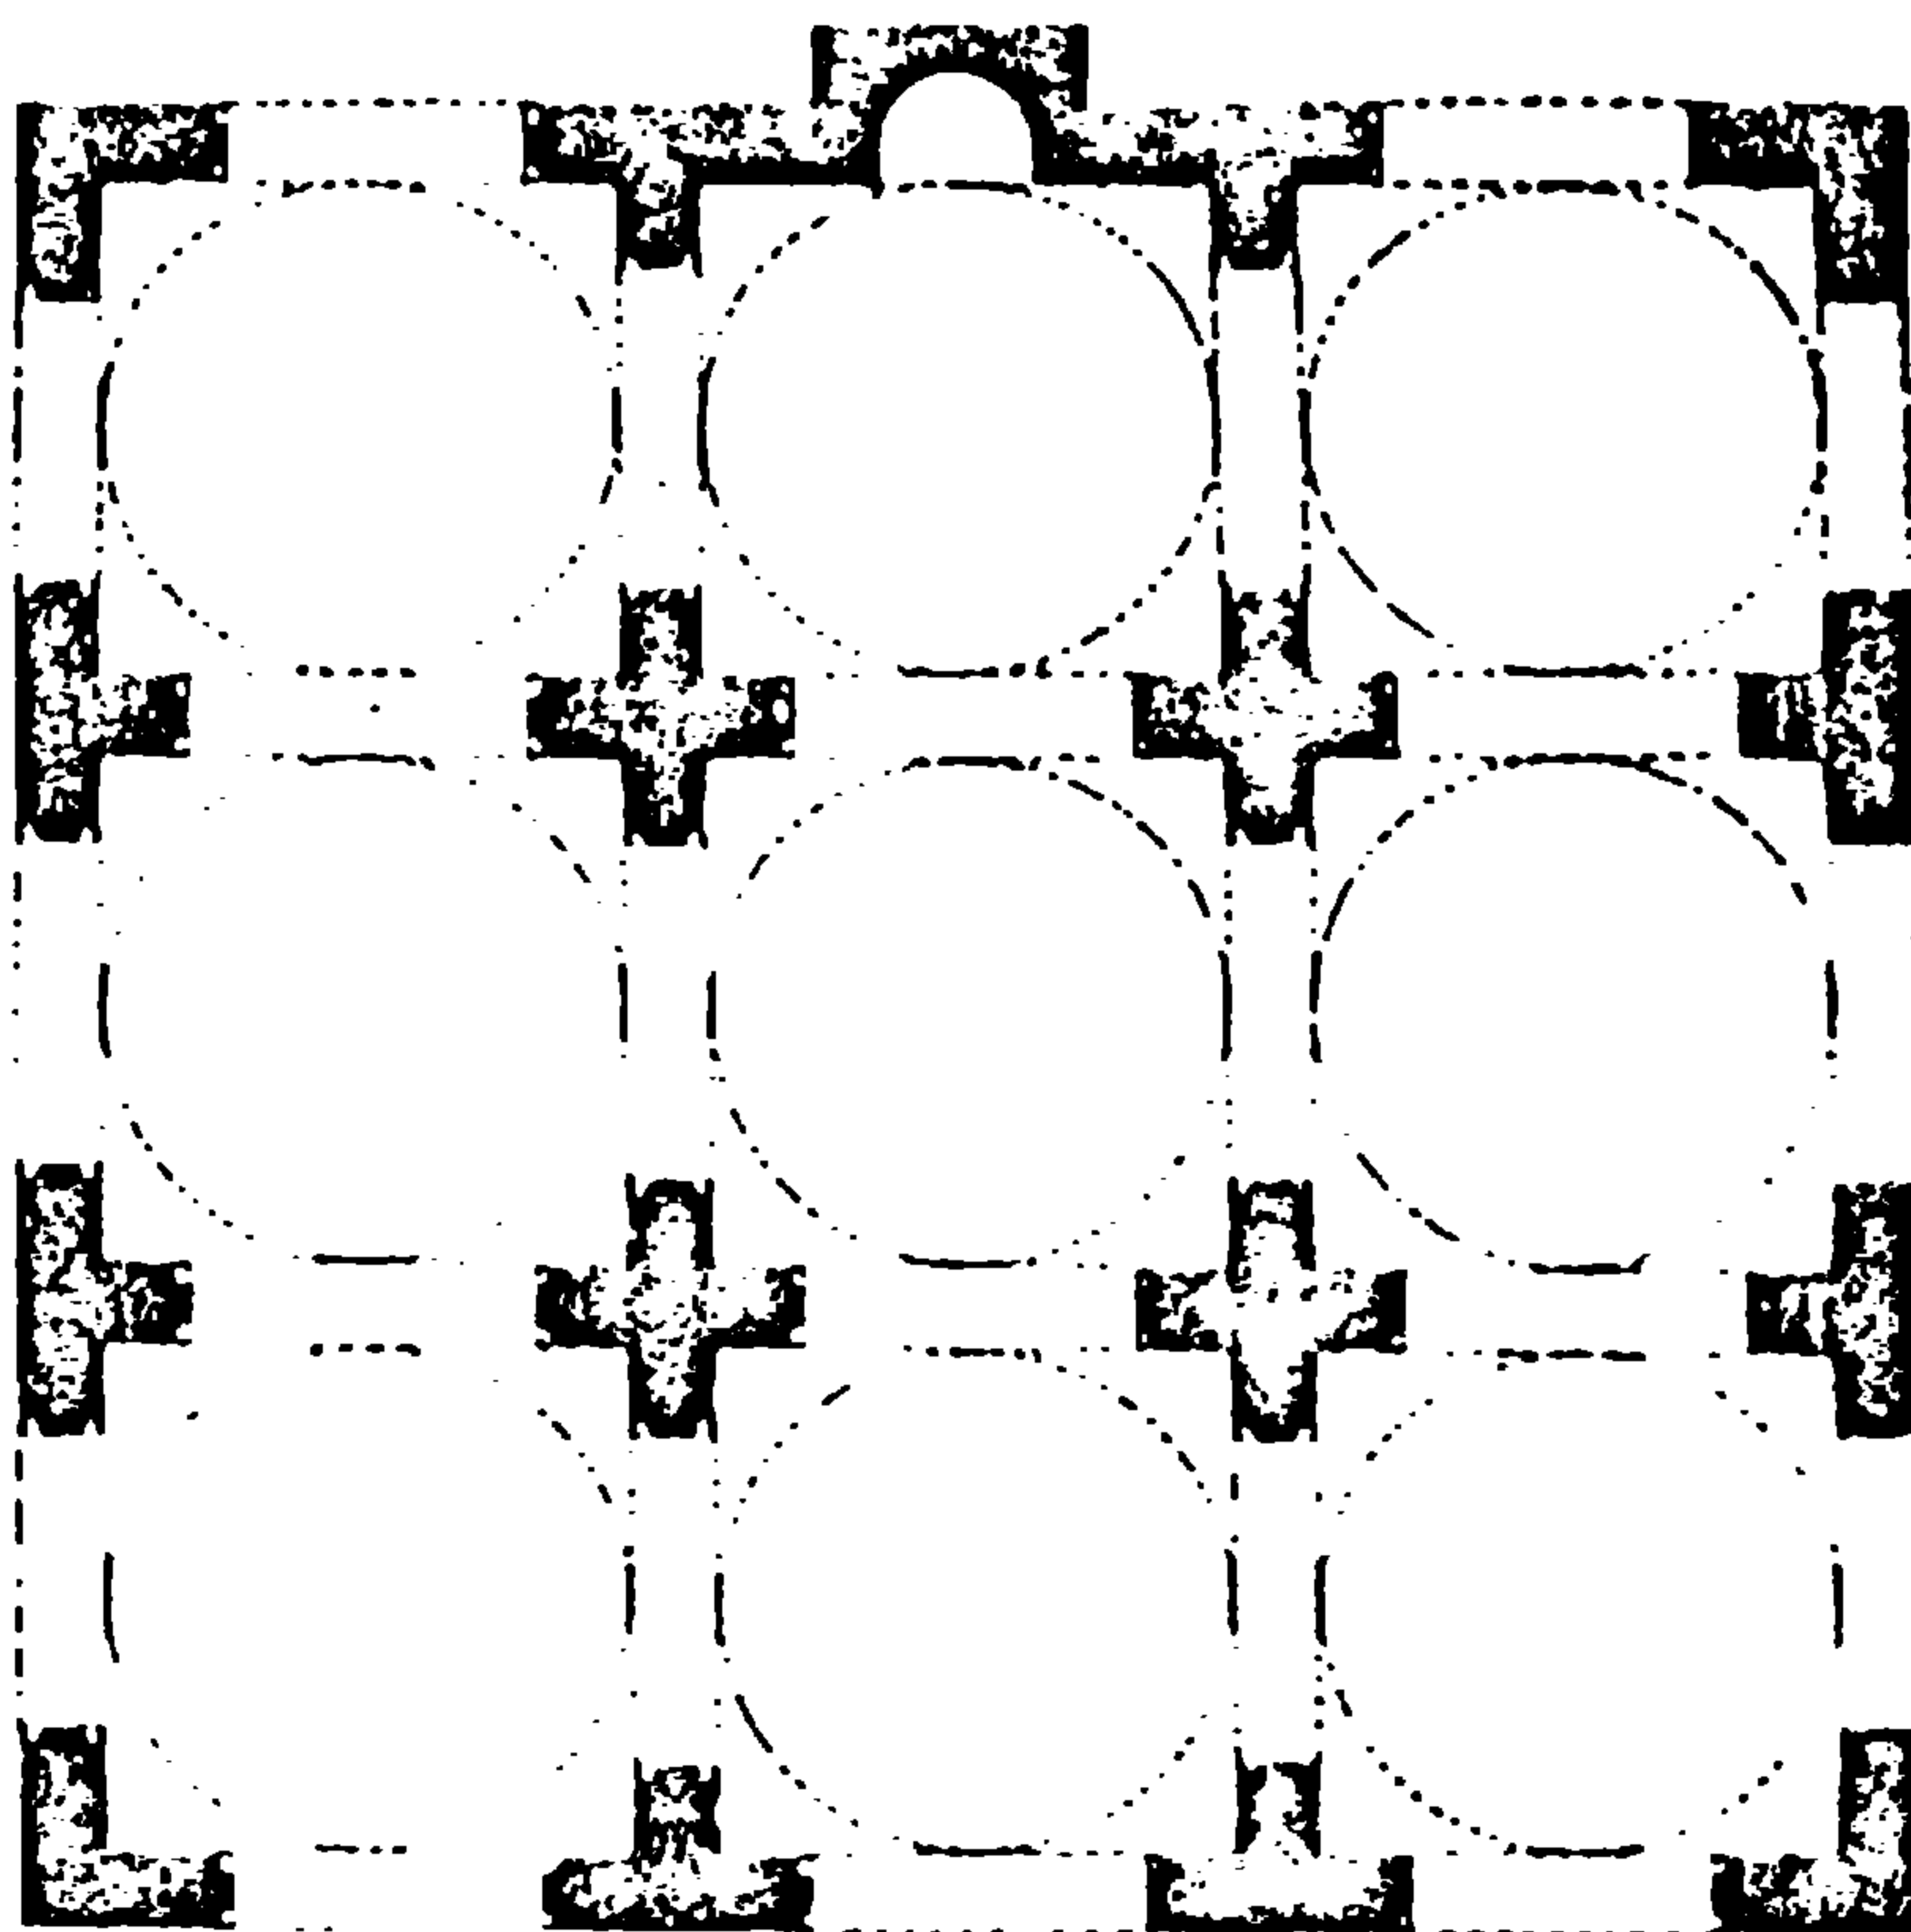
المسقط الأفقى لجامع منان باشا
